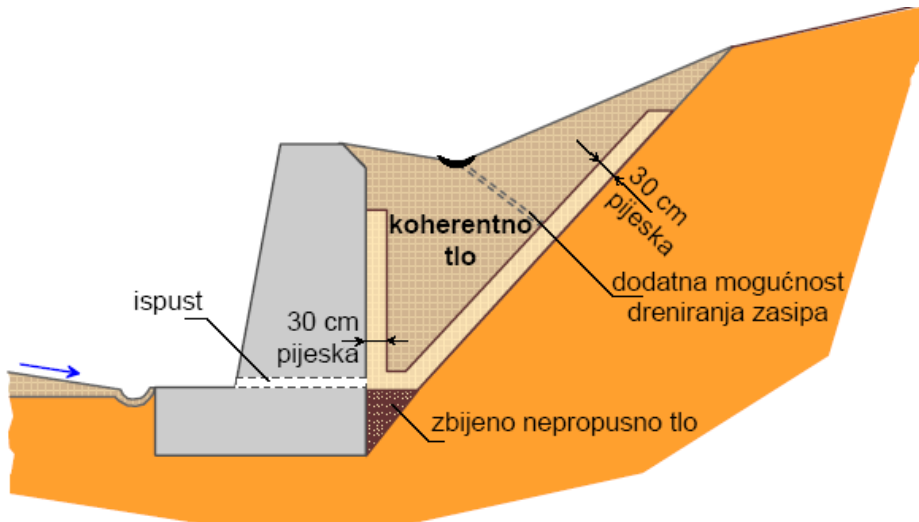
Detalj drenaže i odvodnje u zaleđu vrha potpornog betonskog zida
